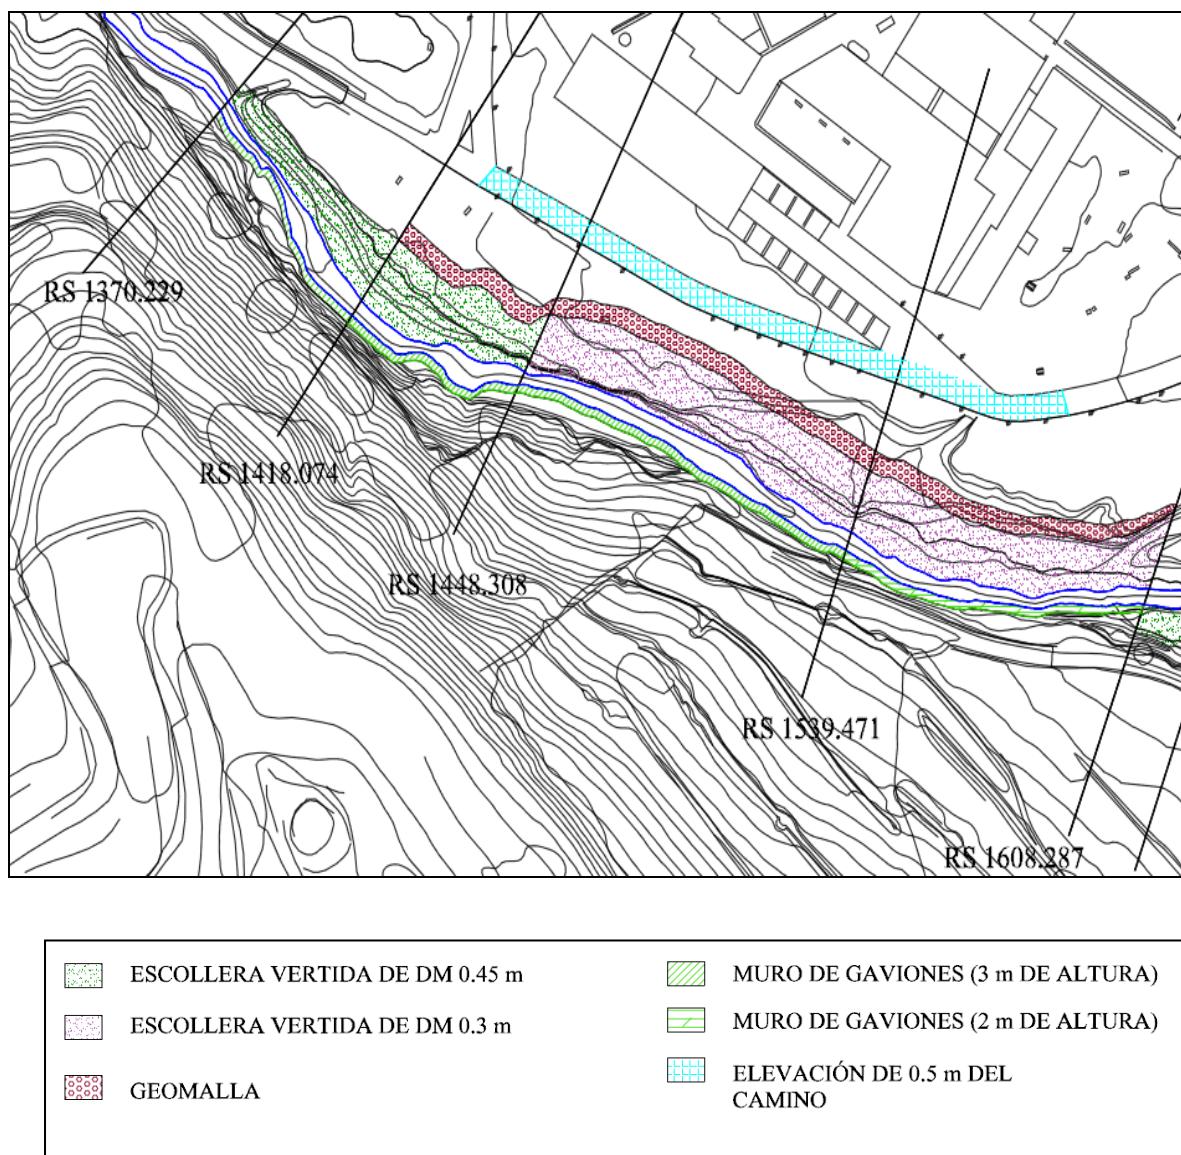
Planta de las actuaciones propuesta para el subtramo 1
